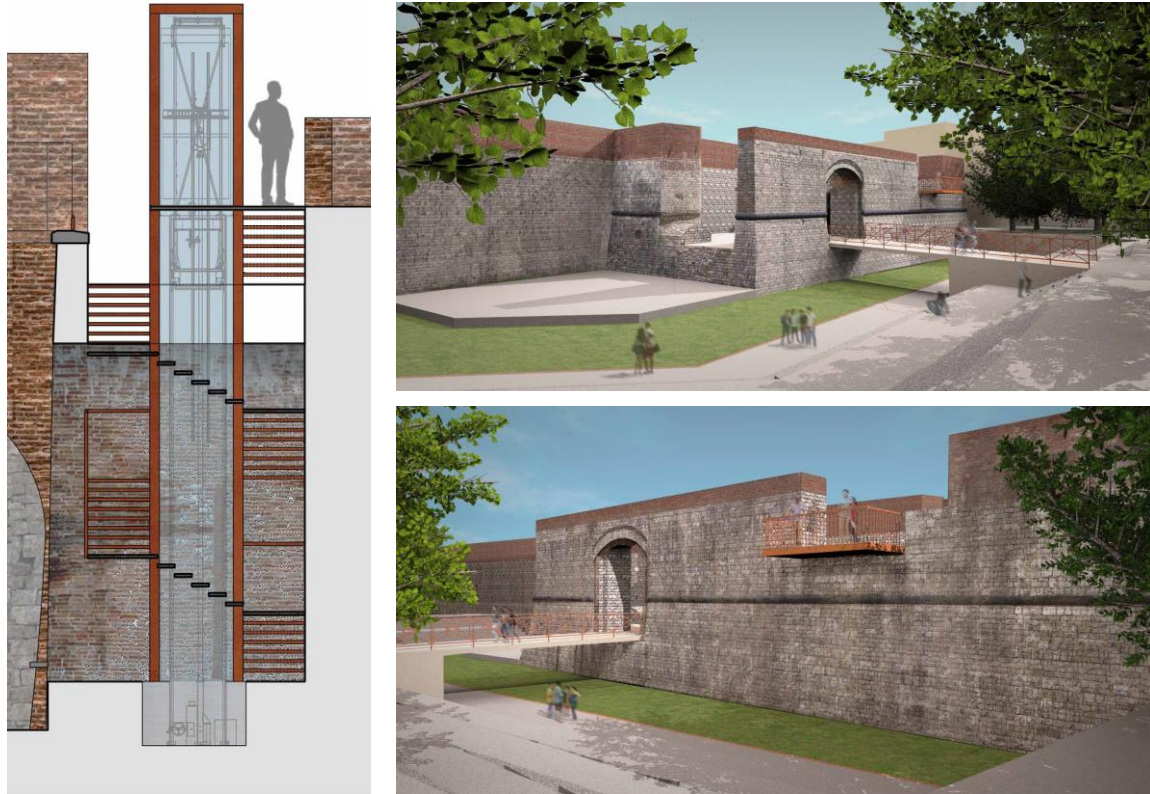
Proposta progettuale: inserimento di collegamenti verticali e viste prospettiche del bastione.
